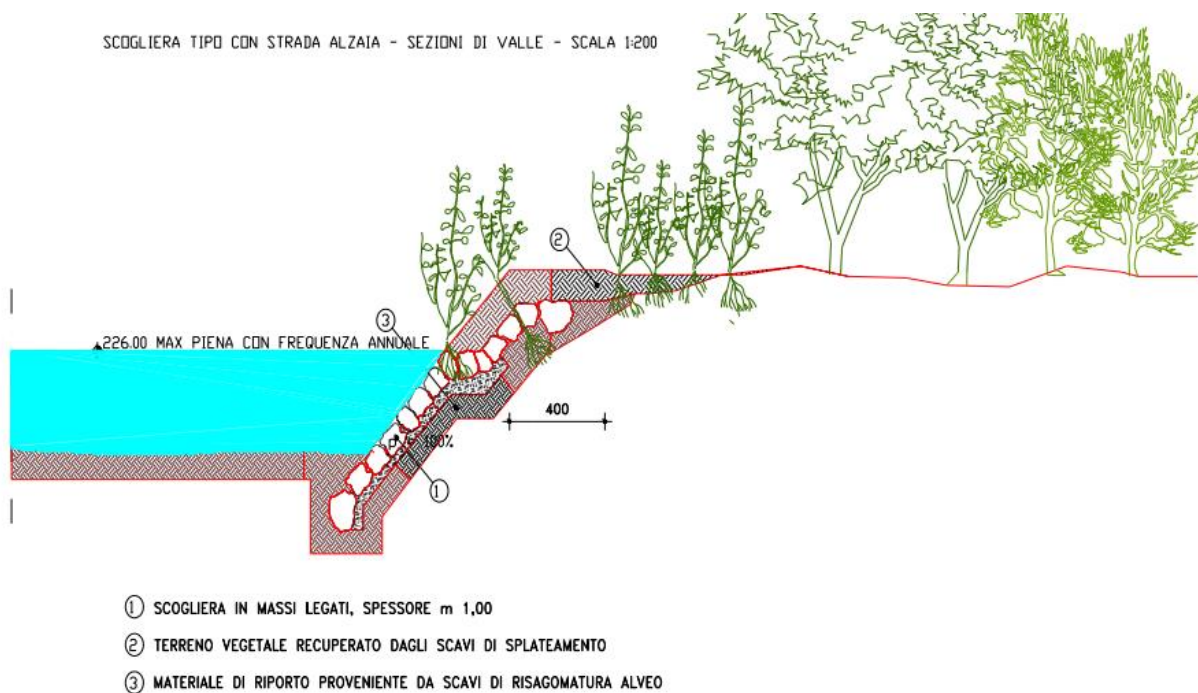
SEZIONE TIPO DELLE DIFESE SPONDALI DI NUOVA COSTRUZIONE CON STRADA ALZAI E RINVERDIMENTO
